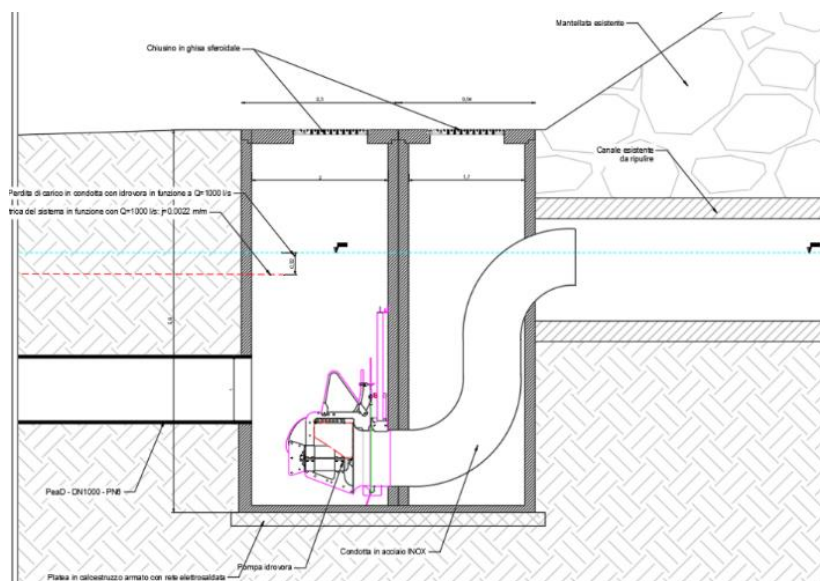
Pozzetti di ricircolo di progetto – sezione trasversale.
